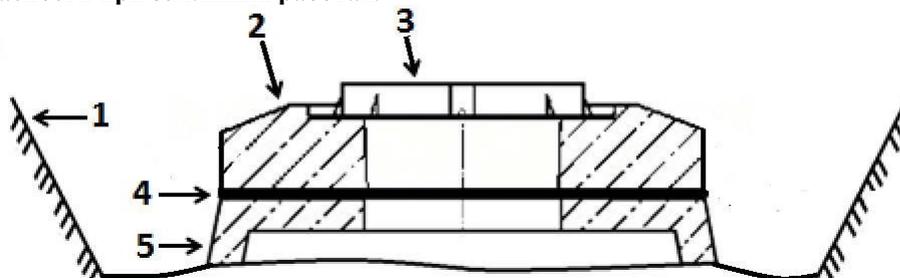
Плита ОП-4 установлена на перекрытие колодца ККСр-4 при новом строительстве.
